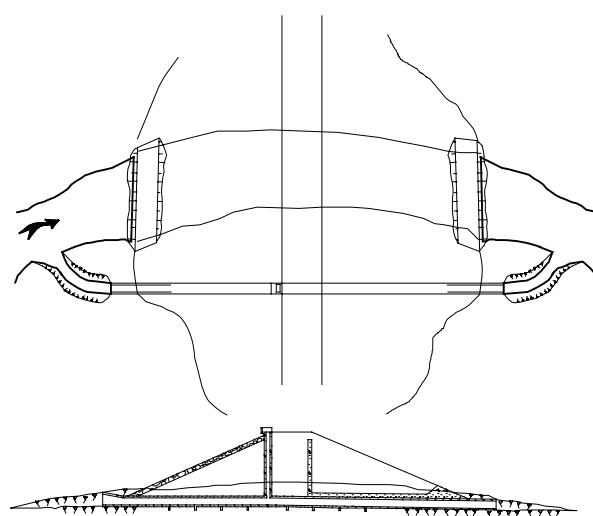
Desvio do rio através de galeria sob a barragem – planta e perfil.
